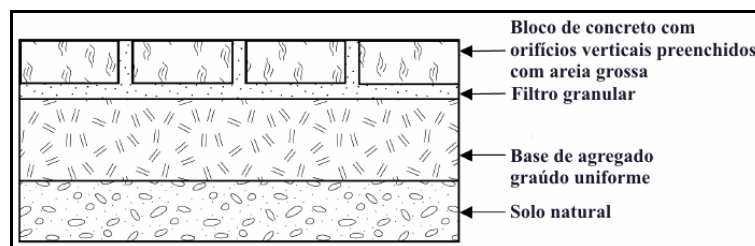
Perfil vertical de pavimento permeável sem armazenagem (traduzido – NJDEP, 2004).
